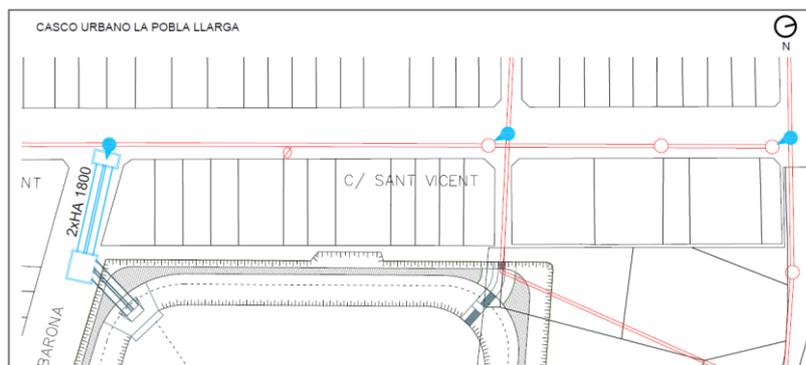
Planos de actuaciones sobre la red de alcantarillado existente
